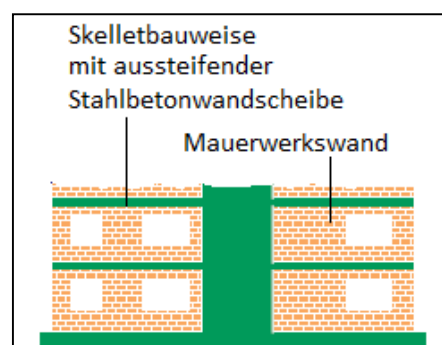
Durchgehende Stahlbetonscheiben im Mauerwerksbau [7]
